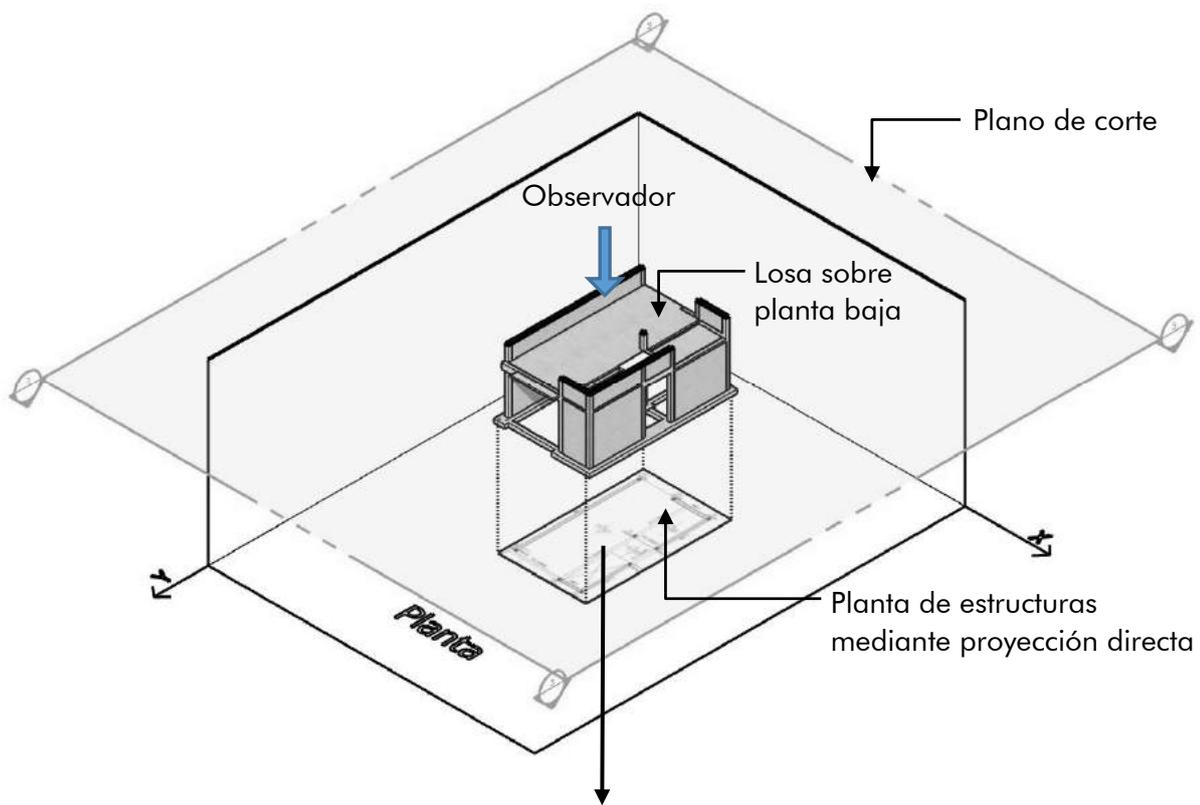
Losa sobre planta baja - Método de proyección ortogonal directa
